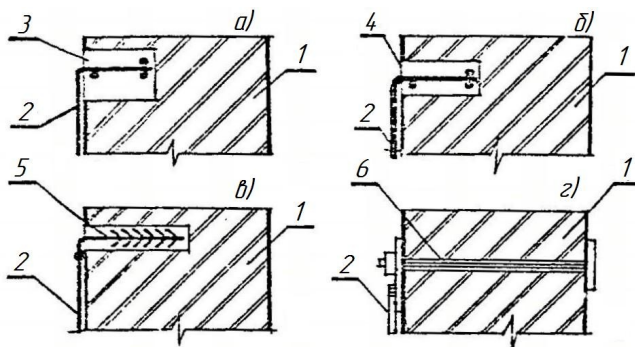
Способи анкерування поздовжньої арматури за допомогою: а – залізобетонних поясів; б – залізобетонних шпонок; в – анкерів; г – тяжів: 1 – верхня (нижня) частина посилюваного елемента; 2 – поздовжня арматура; 3 – залізобетонний пояс; 4 – залізобетонна шпонка; 5 – анкер; 6 – тяж
